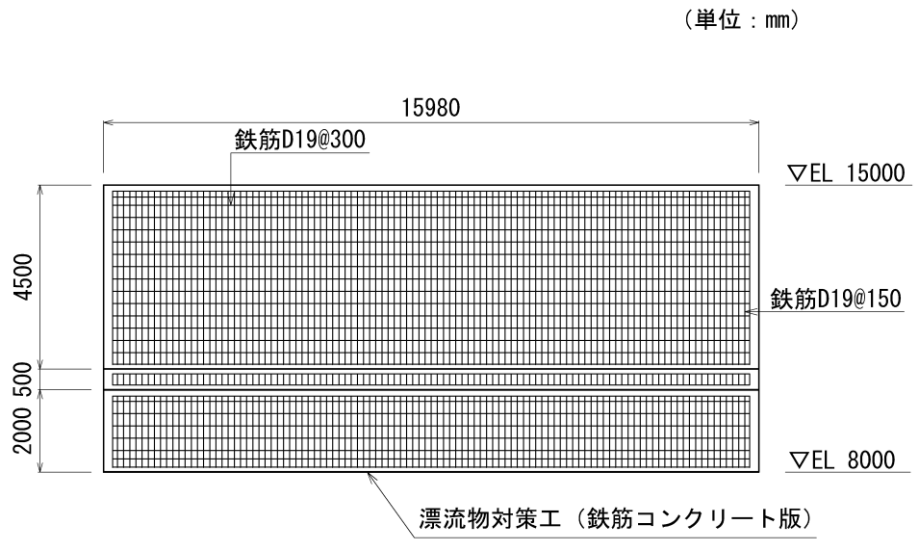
(1) 漂流物対策工 (鉄筋コンクリート版) の概略配筋図 (正面図)
